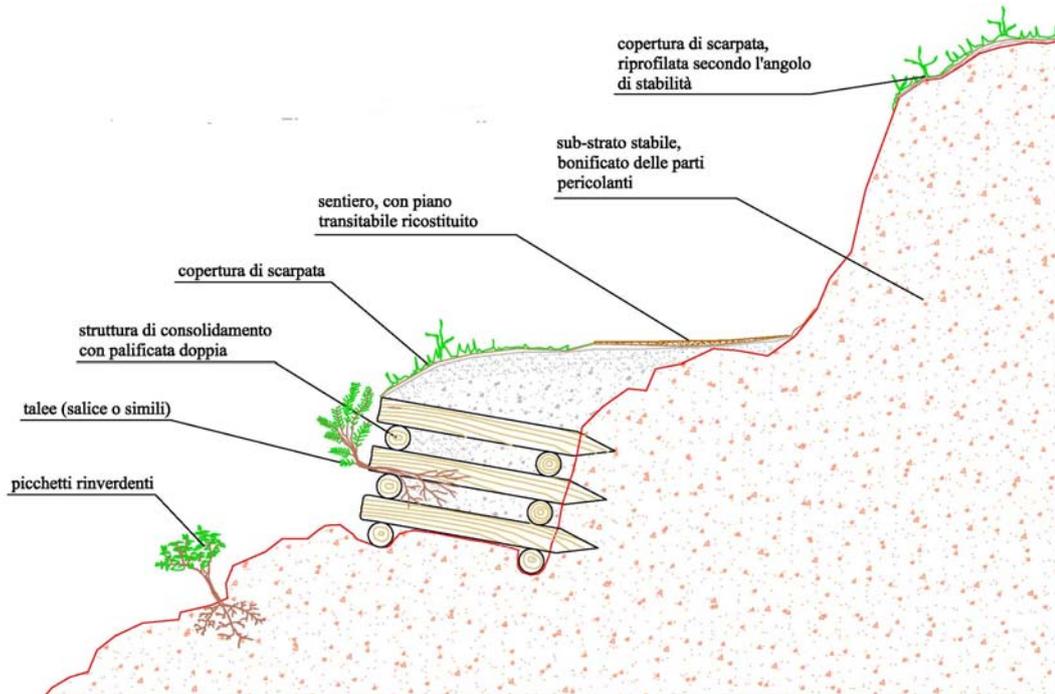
sezione di allargamento del sentiero e consolidamento del versante con una palificata.
